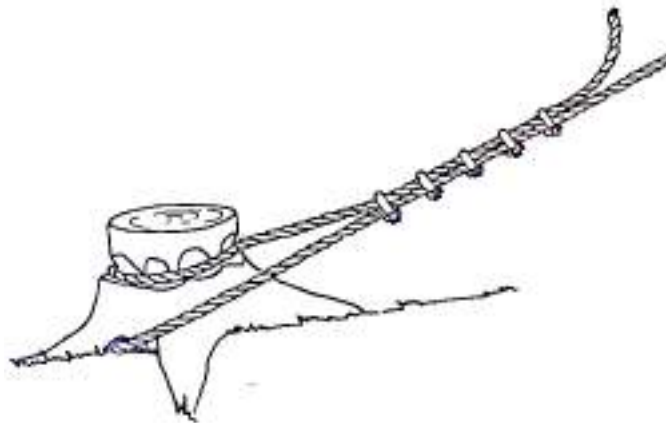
Seilverankerung an einem Wurzelstock (Schweizer Armee).
